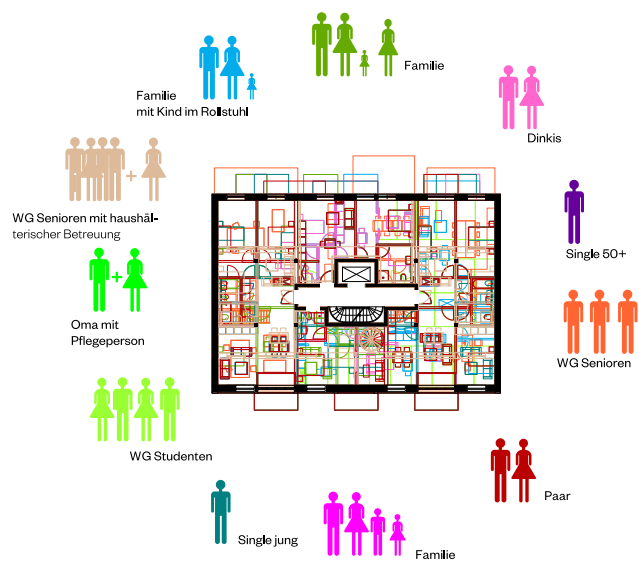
Konzeptverfahren Schöneberger Linse, Berlin, flexible Grundrisskonzeption (Quelle ZRS)
